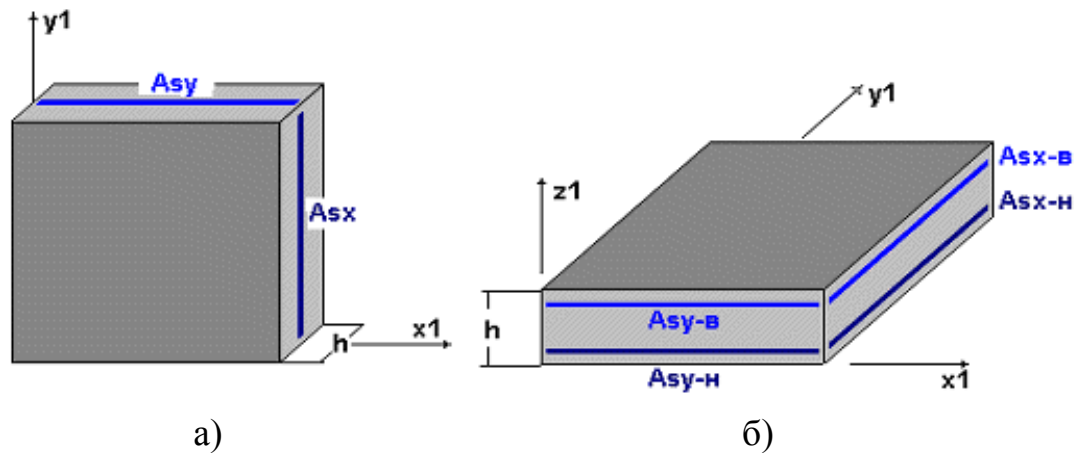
Схеми розташування поздовжньої арматури модуля ЛІР-АРМ ПК «ЛІРА САПР» [25]: а - балок-стінок, б - плит і оболонок
